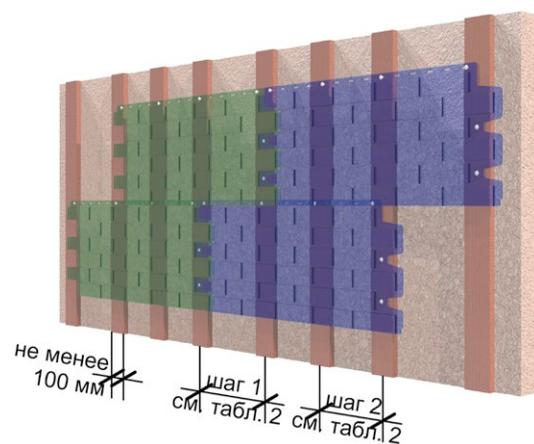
Вертикальная обрешётка под фасадные панели Döcke BERG и ДЮФУР (для фасадных панелей ДЮФУР шаг 1 меньше, чем шаг 2)
